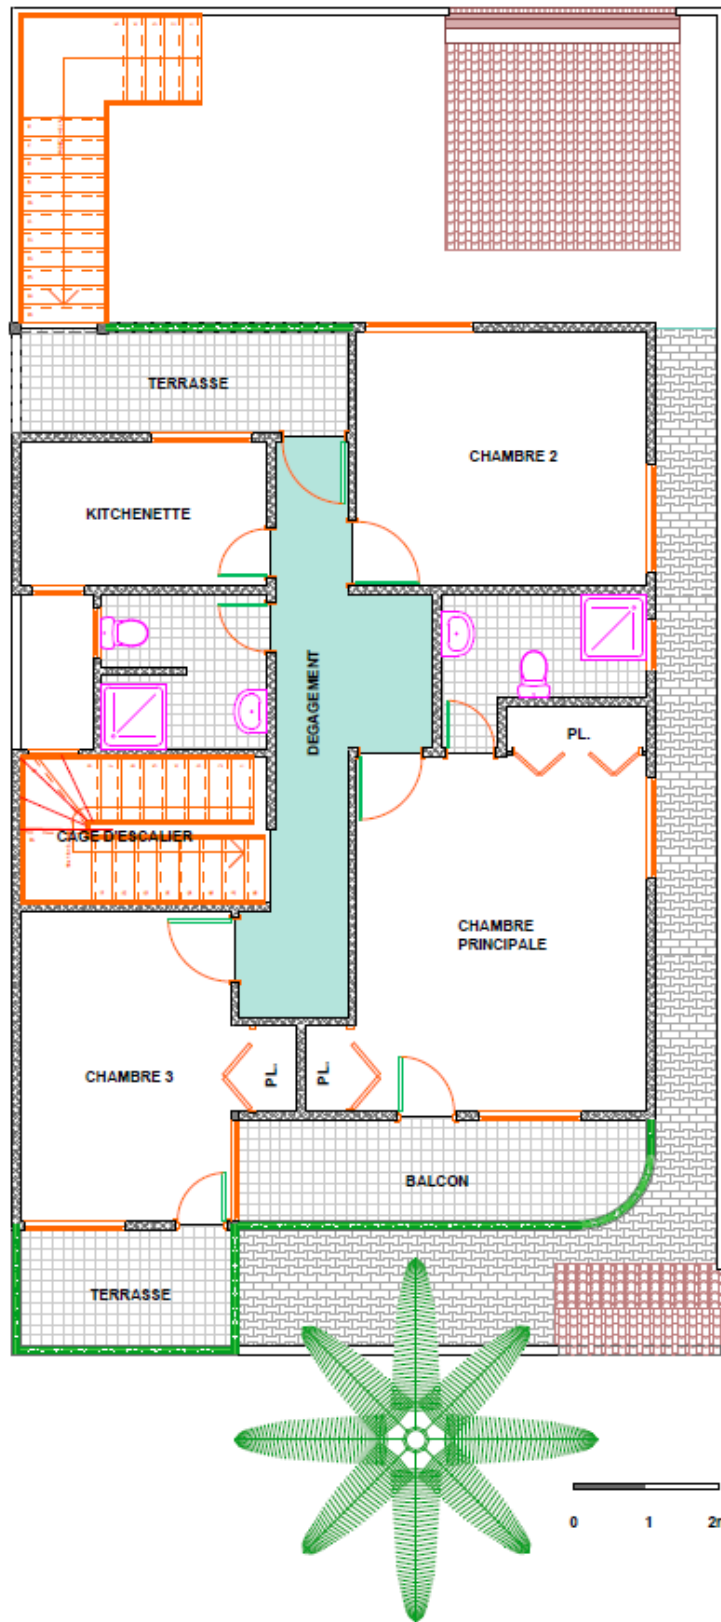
Plans de la maison individuelle de Monsieur O.D. : Étage en cours de construction. Plans reproduits par l'auteur, 2015.
